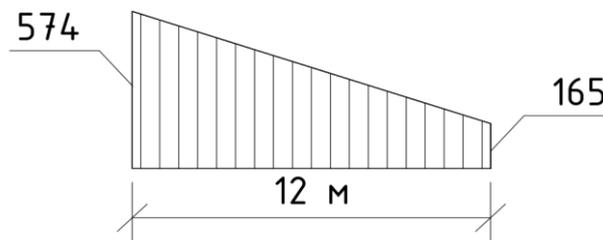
Схема распределения веса снегового покрова в месте перепада профиля кровли
